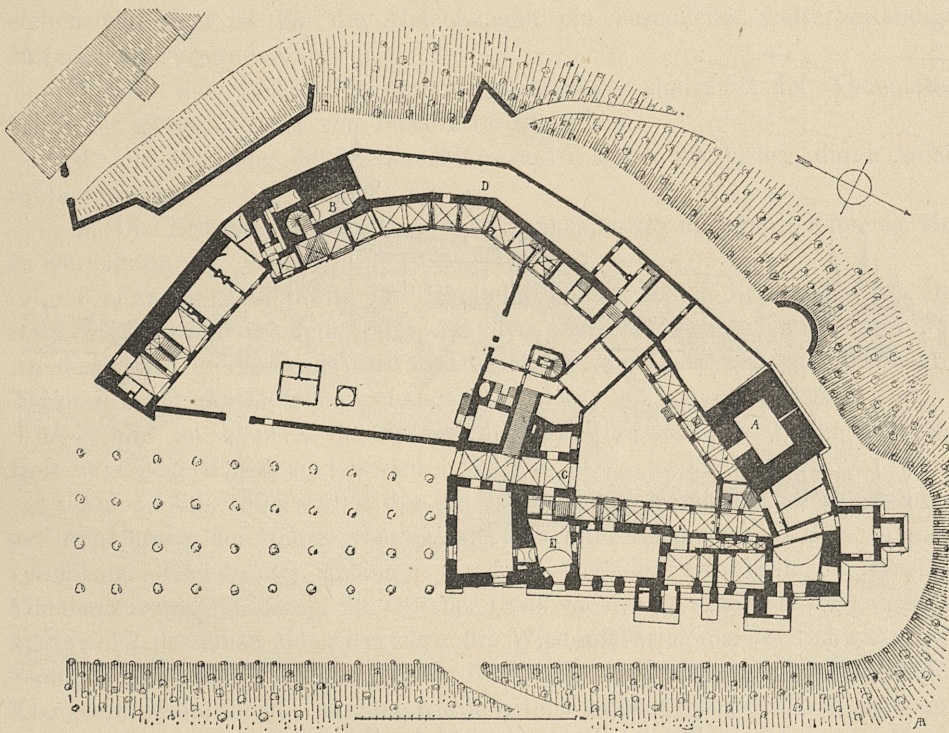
Kleve. Grundriss des Schlosses.
